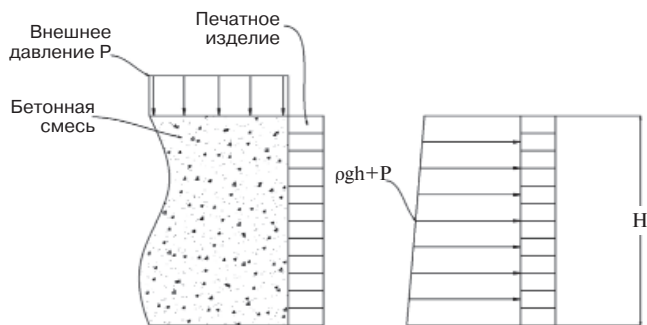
Схема работы формообразующего элемента несъемной опалубки под воздействием бокового давления и дополнительной нагрузки (слева) и эпюра нагрузки по высоте конструкции (справа): ρ – плотность бетонной смеси; g – ускорение свободного падения; h – переменная высота; H – полная высота заливки смеси; P – внешнее (дополнительное) давление на поверхность смеси
